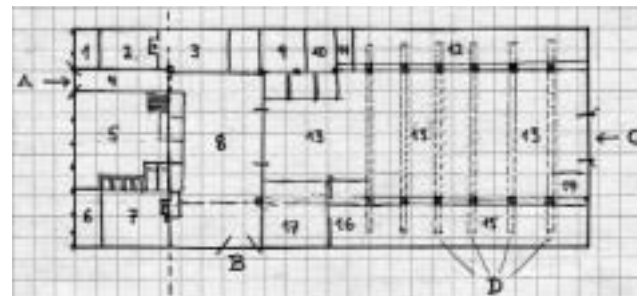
Grundrisskizze: Raumaufteilung
